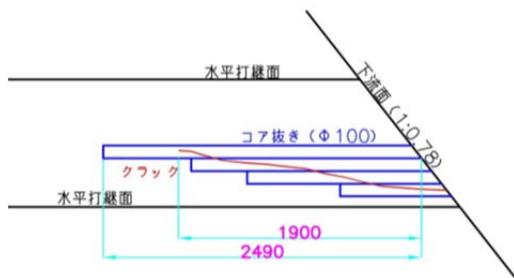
ひび割れ深度調査 (コア採取)
